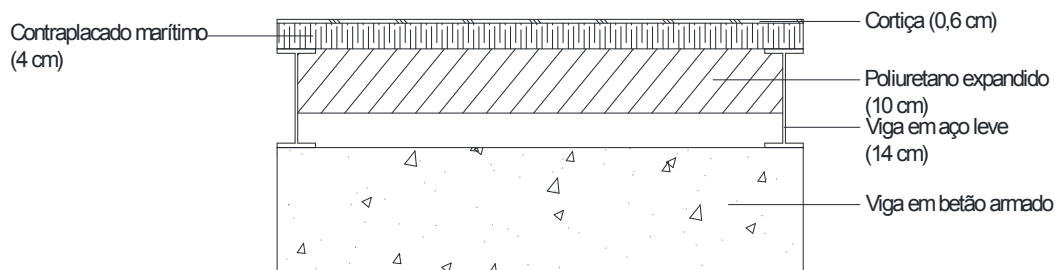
Laje de piso com estrutura de suporte em vigas de aço
